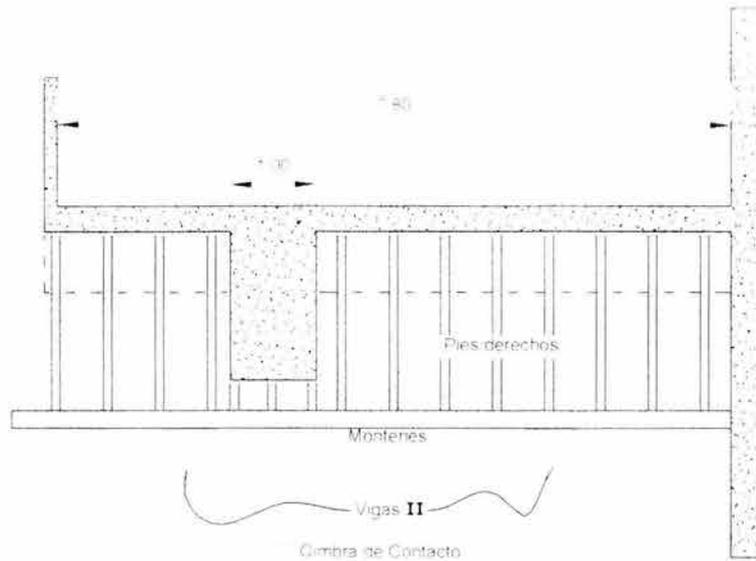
Trabajos para cimbra del acceso a Galería de Oscilación.
